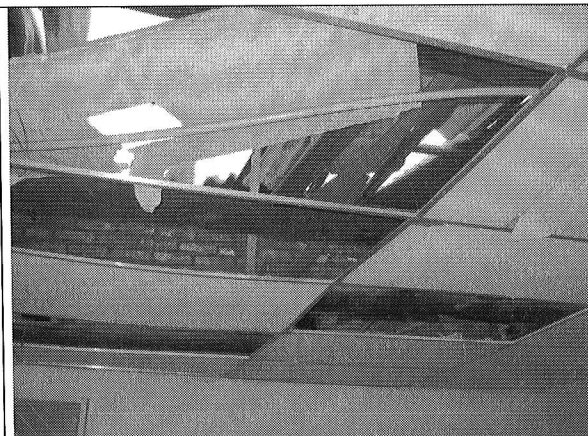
Grieta y deformación de vanos de puertas.
